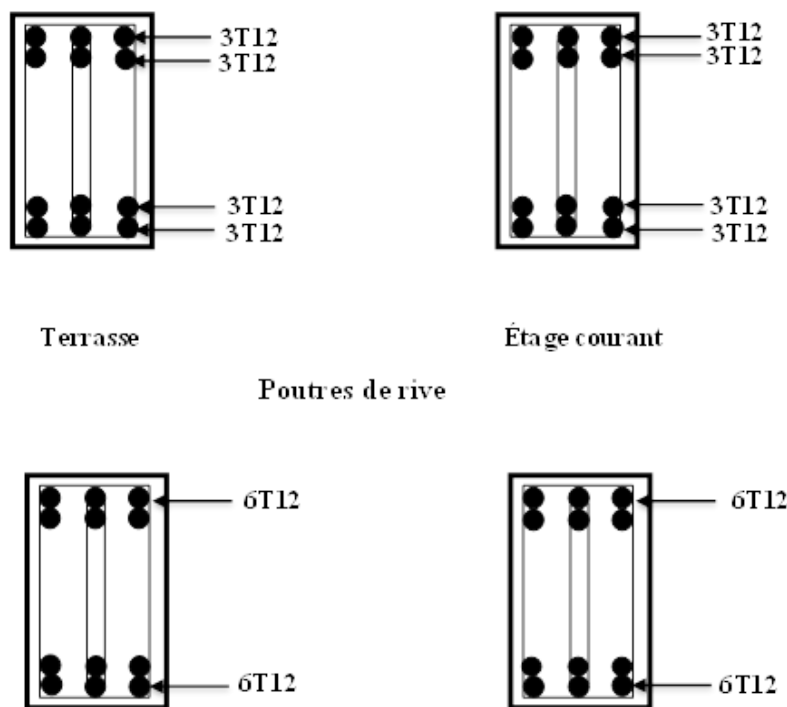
Dessin de ferraillage des sections des poutres Secondaires
